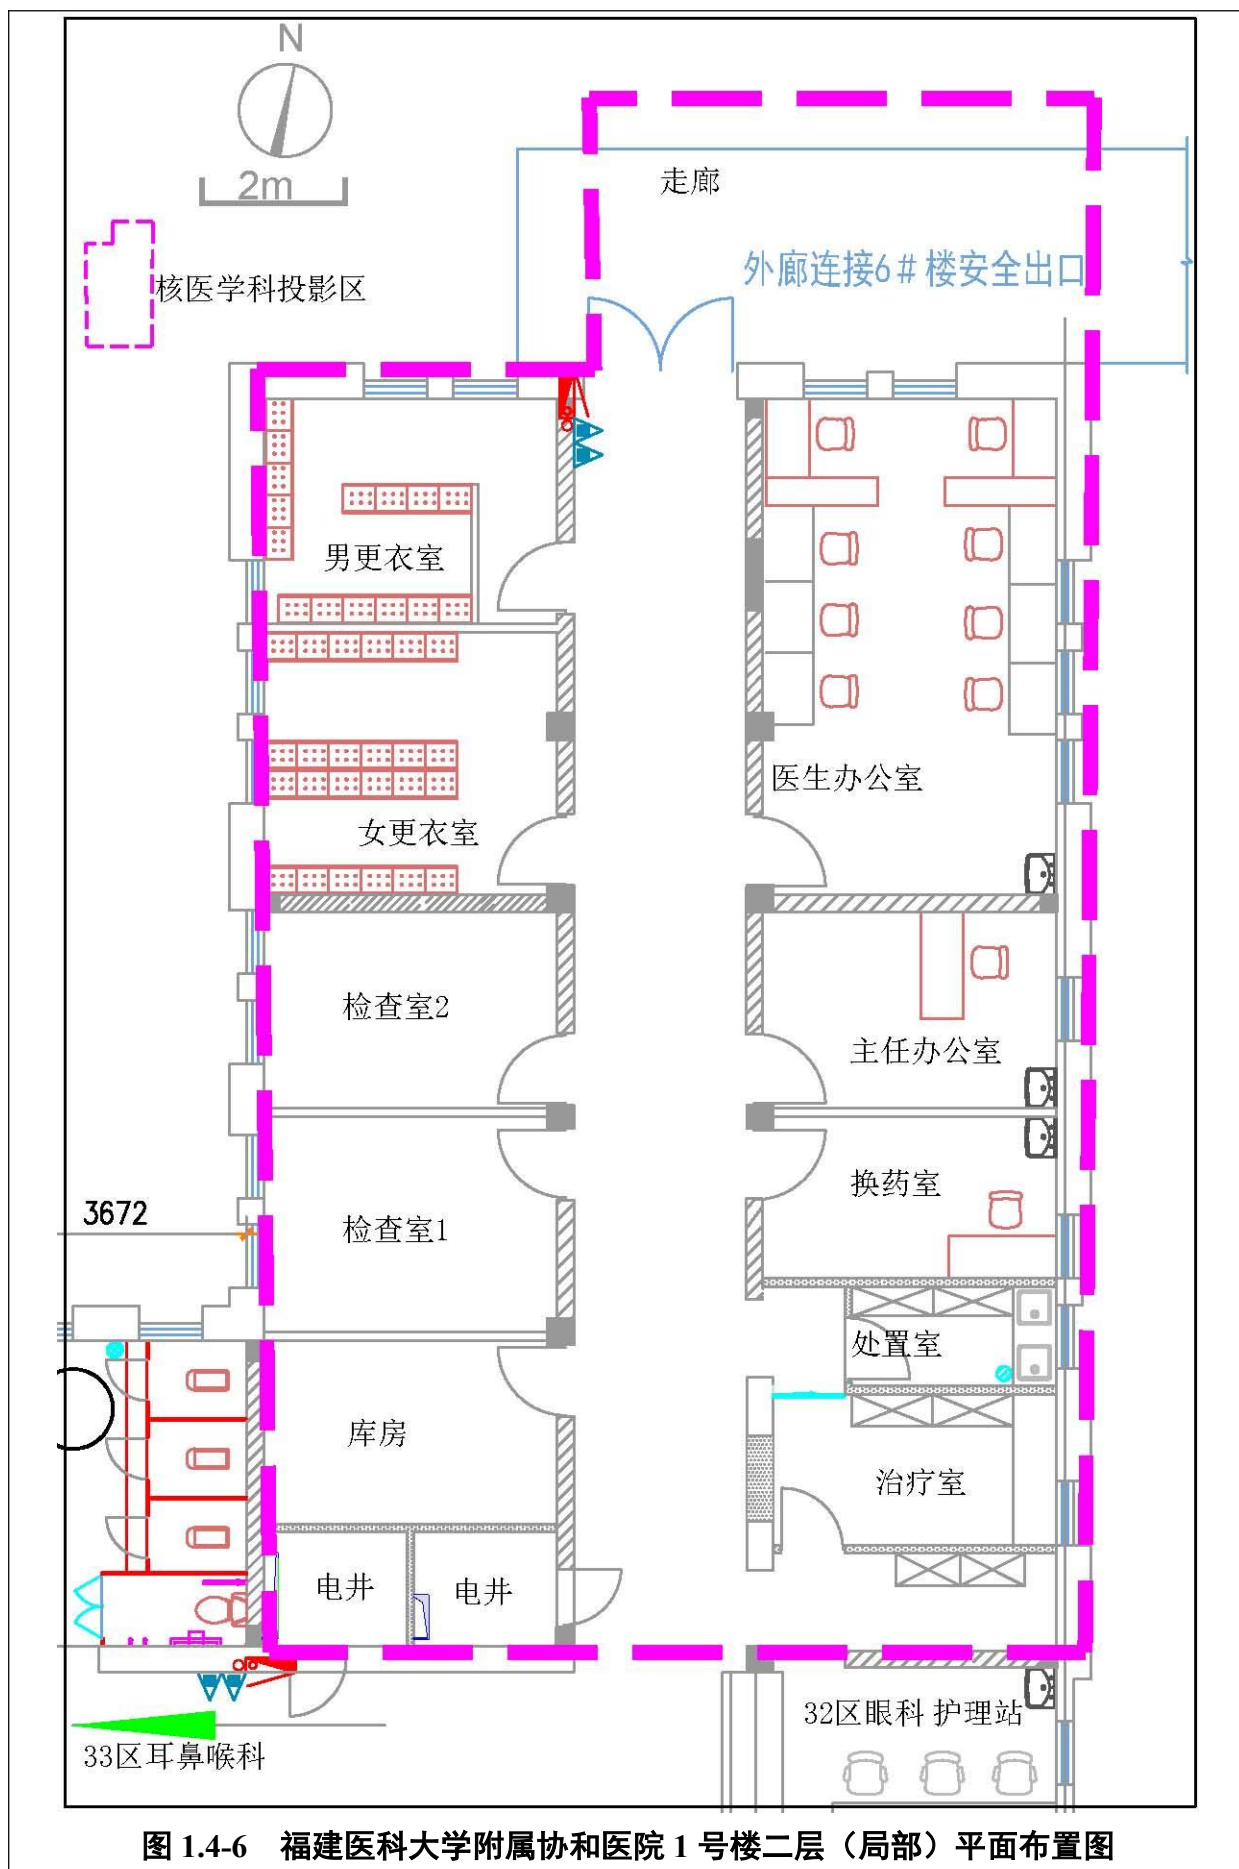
福建医科大学附属协和医院 1 号楼二层（局部）平面布置图
